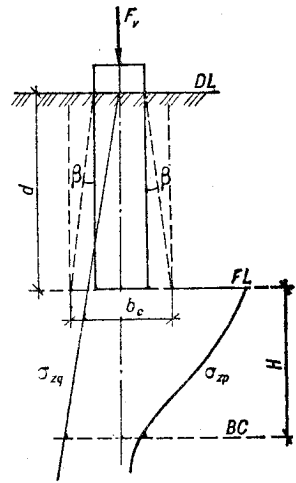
Розрахункова схема осідання фундаменту, споруджуваного без виїмання ґрунту
